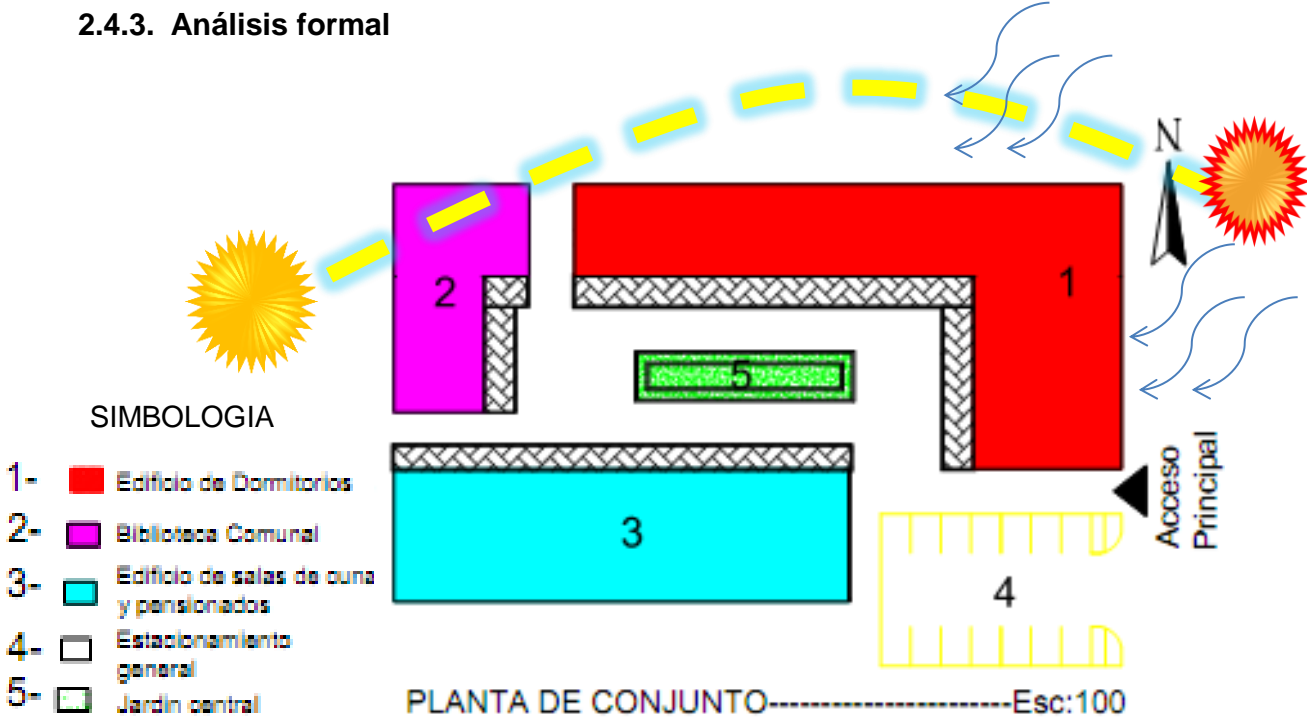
Planta arquitectónica de asilo villa Alhué, Alhué, Chile/
